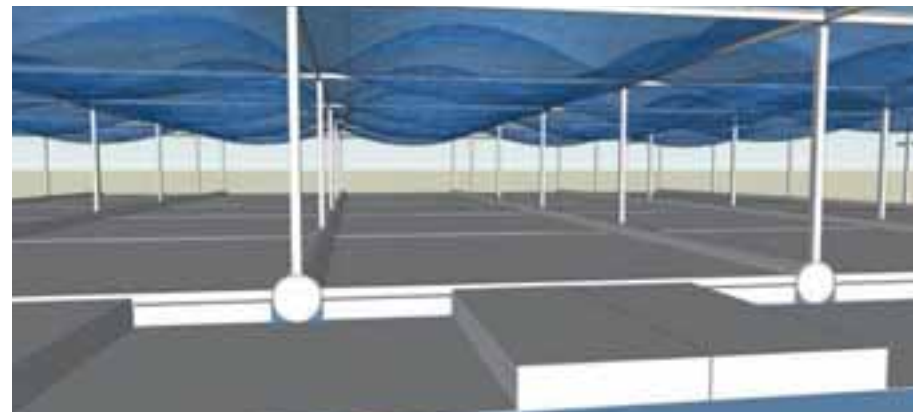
Platen EPS in folie ingepakt, zijn met elkaar gekoppeld. Doordat EPS en folie beide niet erg stijf zijn, is de onderlinge verbinding ook flexibel. De puntlasten van constructie worden door een eigen frame gedragen. Dit frame bezit voldoende drijfvermogen voor het eigengewicht. Een drijvende balk van 600x1000 mm heeft een drijfvermogen van circa 300 kg/m¹. Dus bij een pootbreedte van 5 m is dit 60 kg/m². De EPS-platen dragen het gewas.
